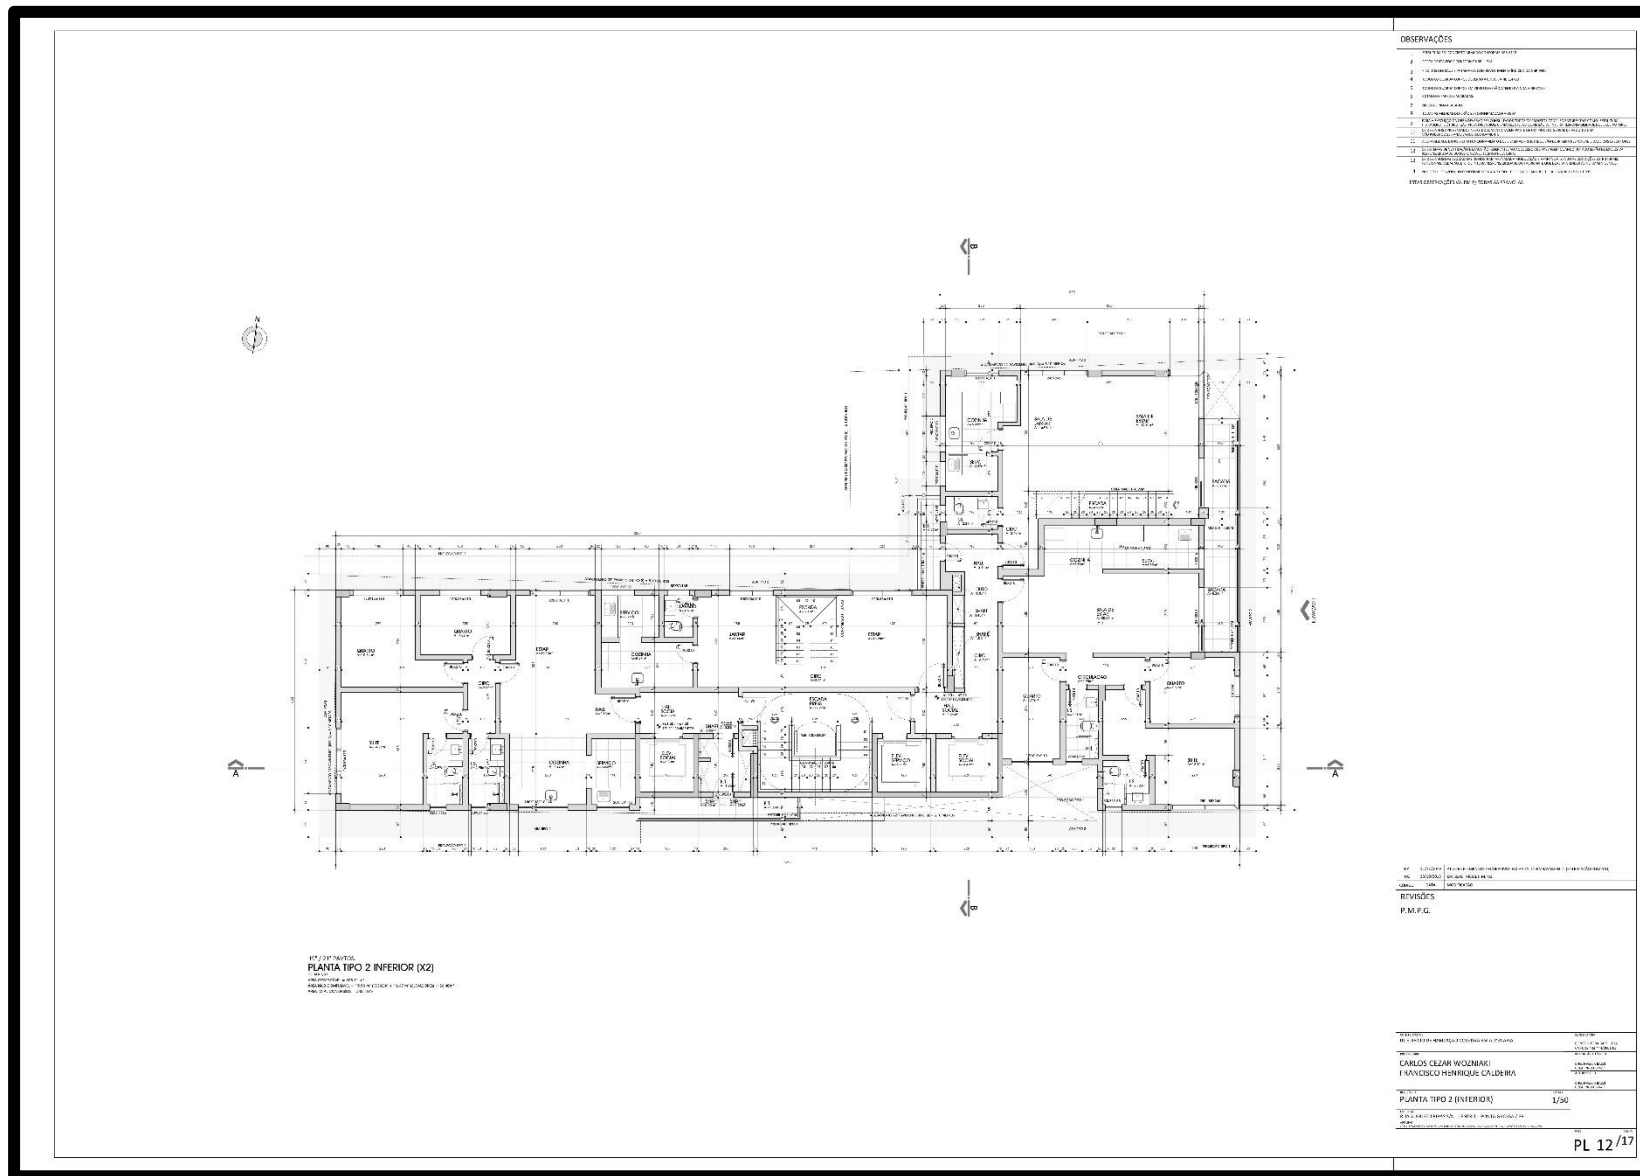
Planta pavimento tipo 2 inferior (x2 – décimo nono e vigésimo primeiro pavimentos). Fonte: Construtora Bazzi (2020).
